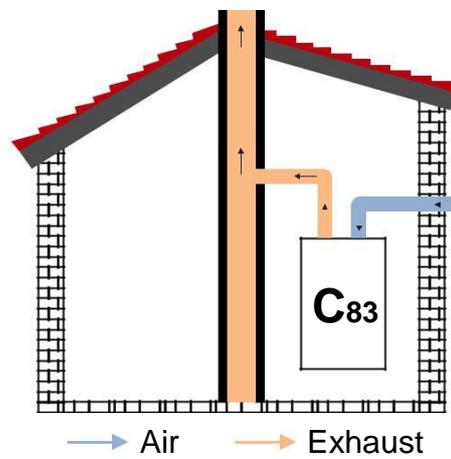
Separación hermética de la chimenea y construcción de chimenea.
